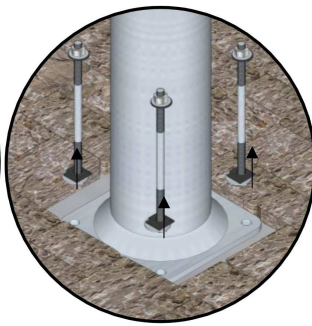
Detalle constructivo de instalación de postes de aluminio de iluminación LED.
